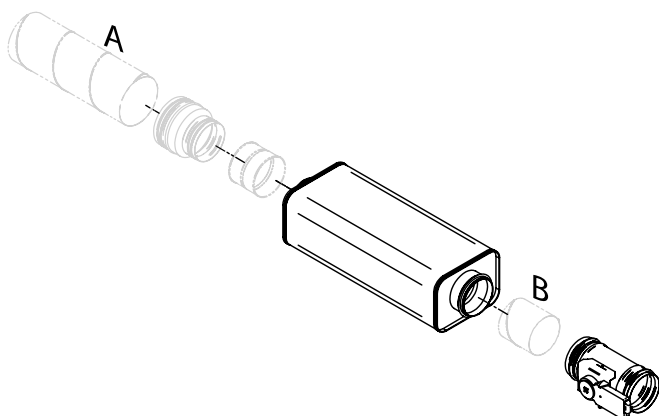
Kit d'air introduit, PARAGON T-SAK-VAV-100
